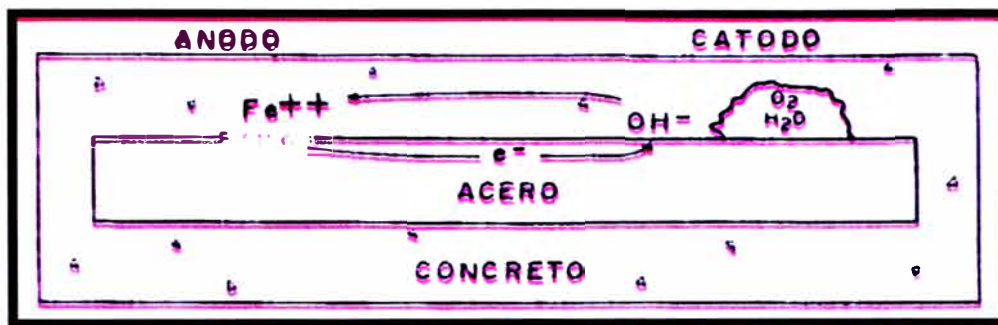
Celda de corrosión en concreto reforzado
